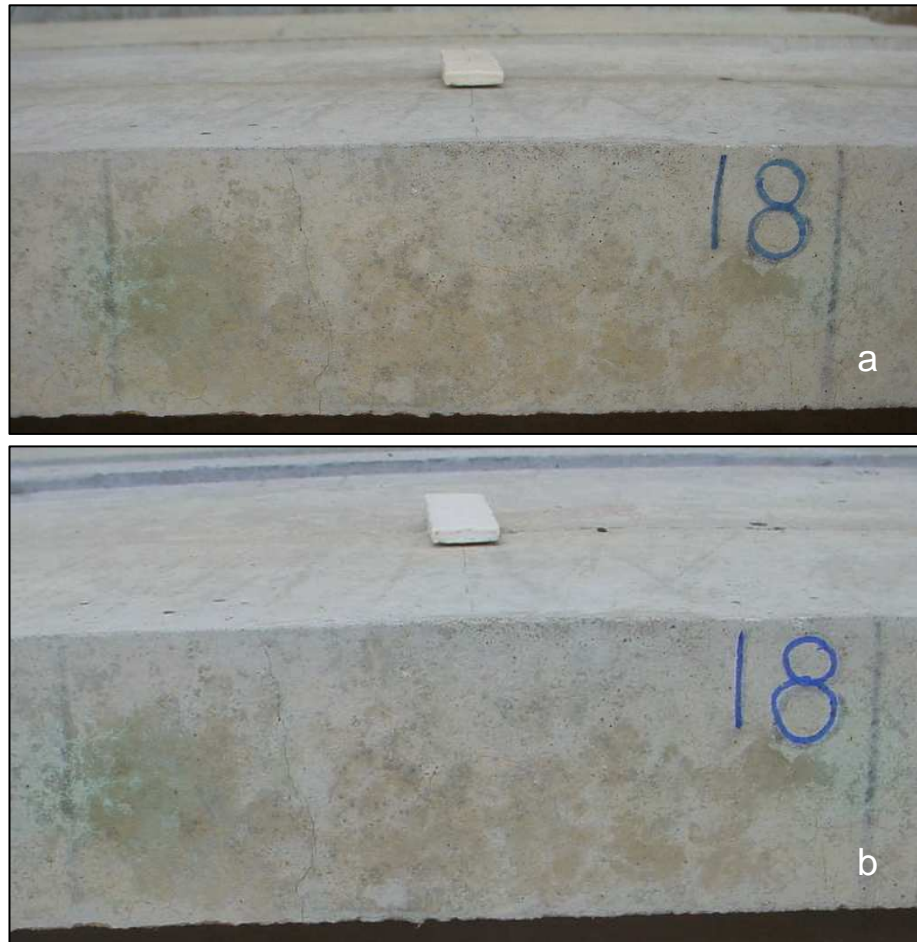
Fisuras observadas en la viga 18.
